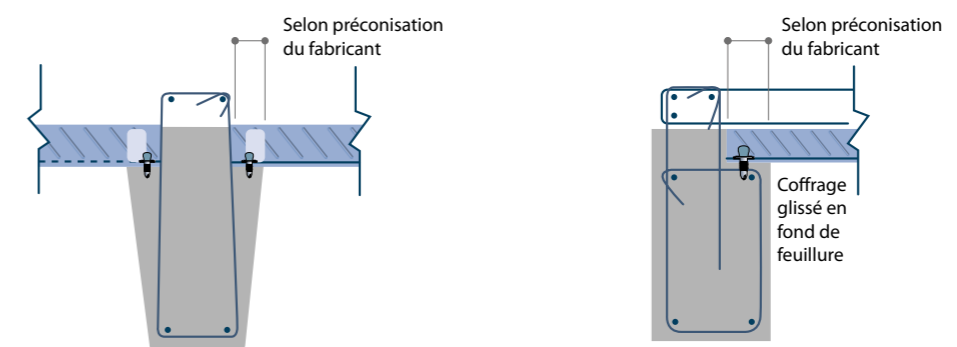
Exemple de pose des bacs sur appuis béton préfabriqués
